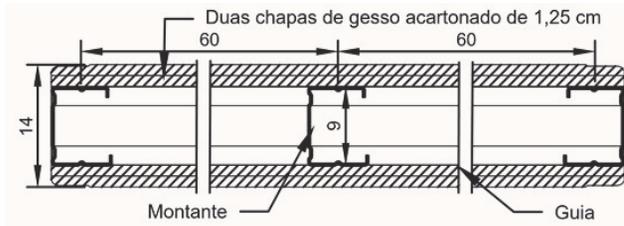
Corte horizontal da parede drywall tipo X140/90/600/4ST1,25
